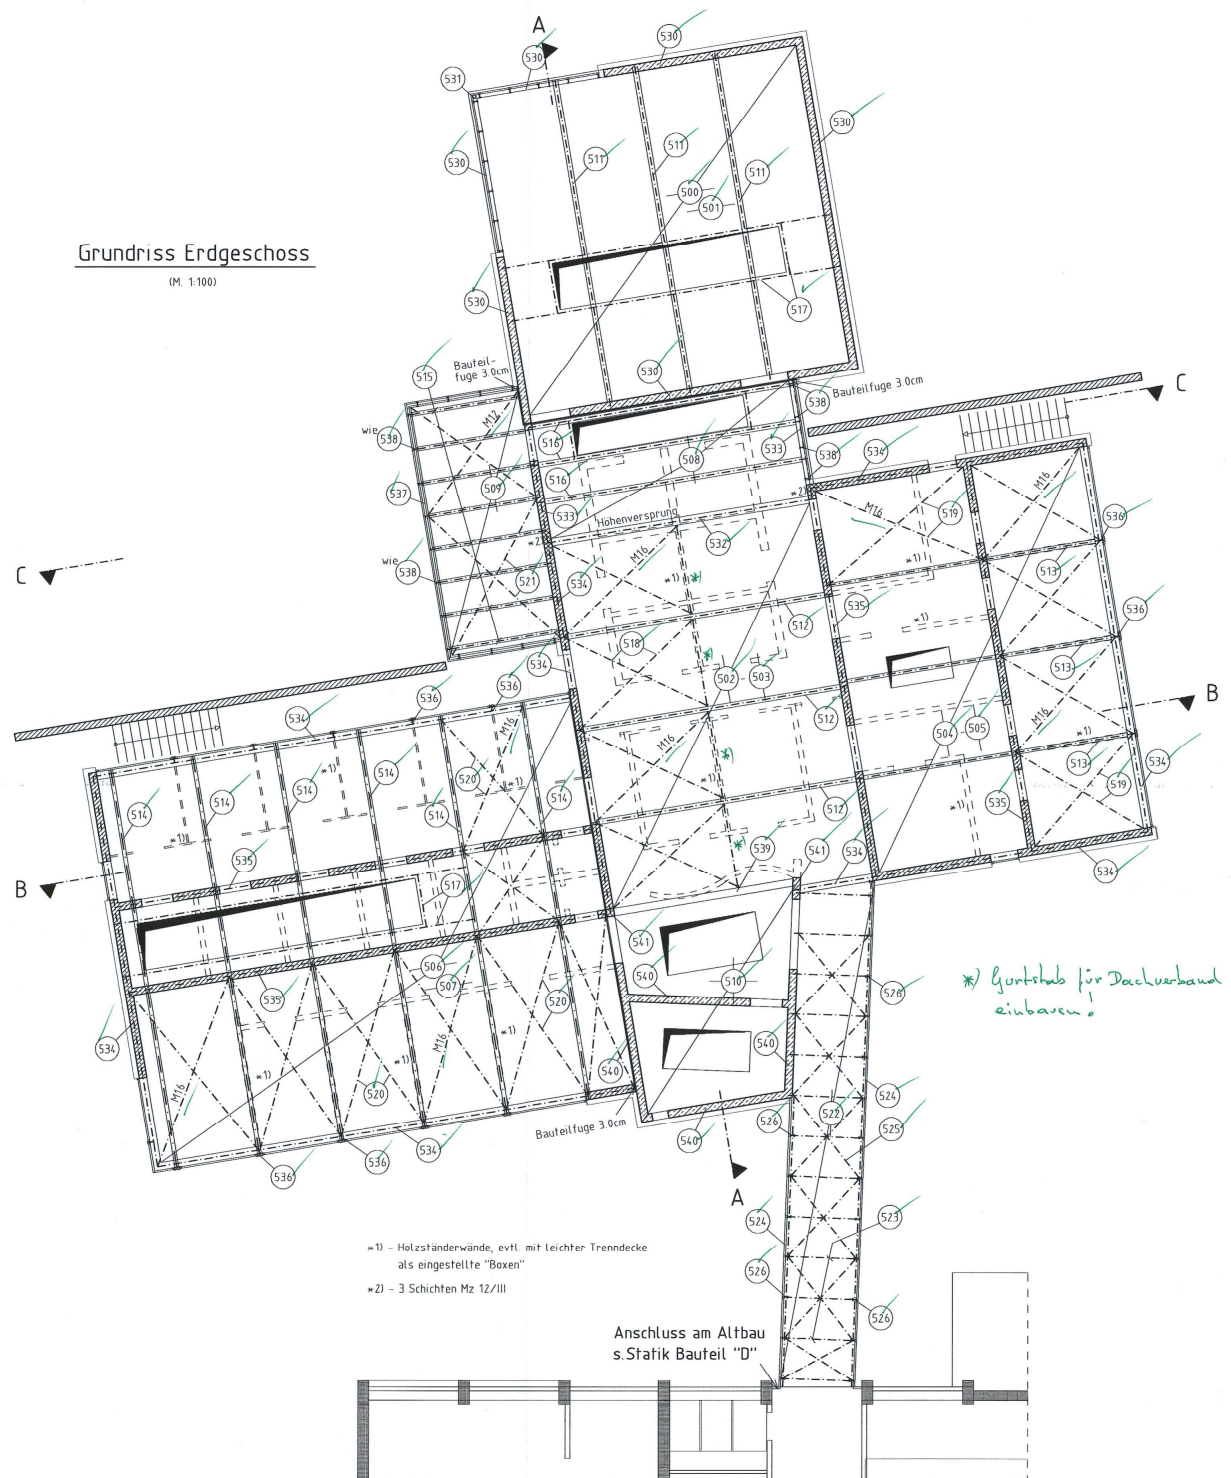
Positionsplan P6 Grundriss Erdgeschoss vom 15.10.2003
